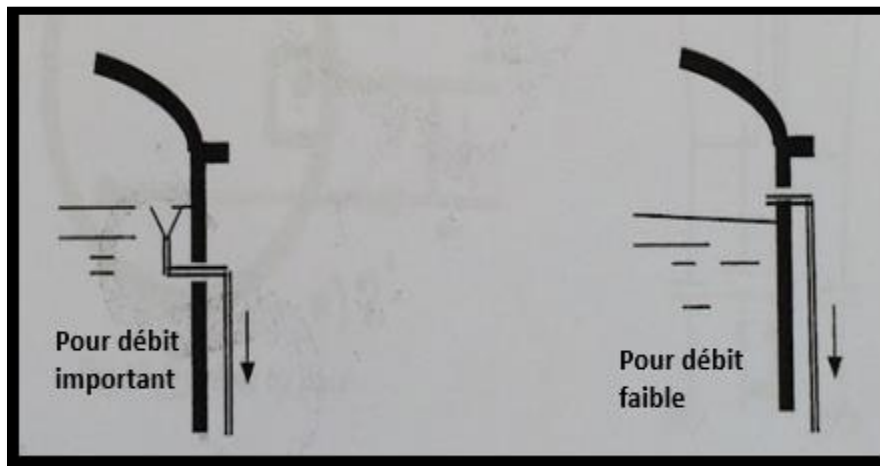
Conduite de trop-plein (Source : SALAH B., 2014)
